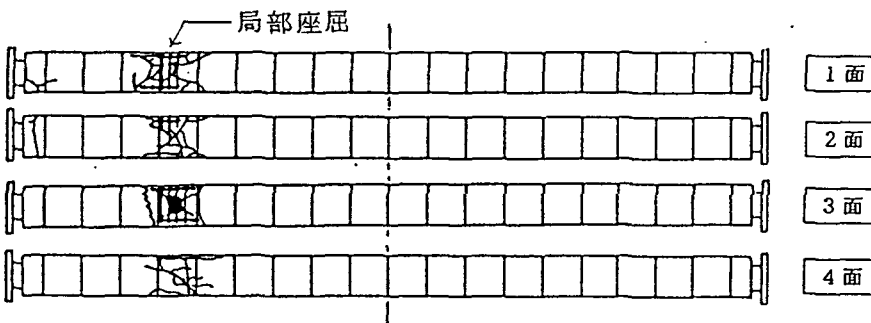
被覆材のひび割れパターン (C-2 試験体、最終状況)
